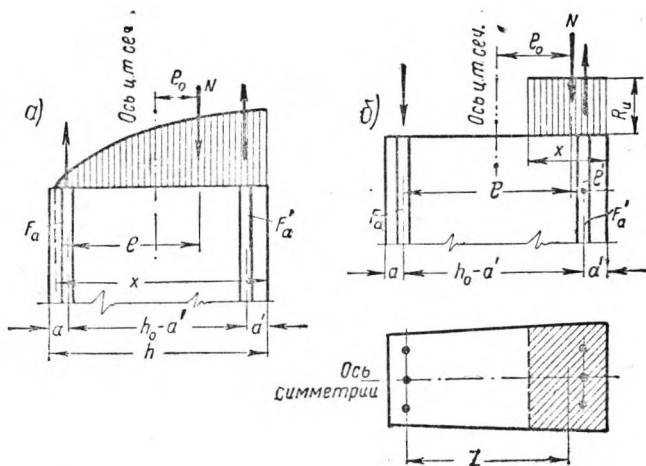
Схемы к расчету внецентренно сжатых сечений с продольной арматурой
